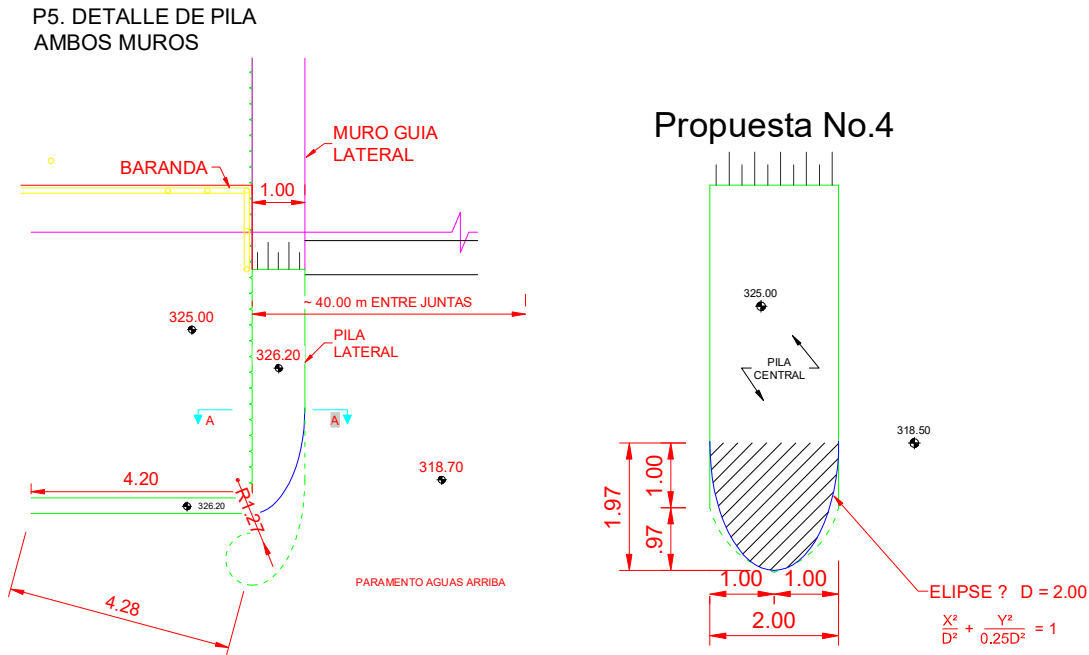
Perfil de accesos laterales P5, pilas centrales No. 4.
